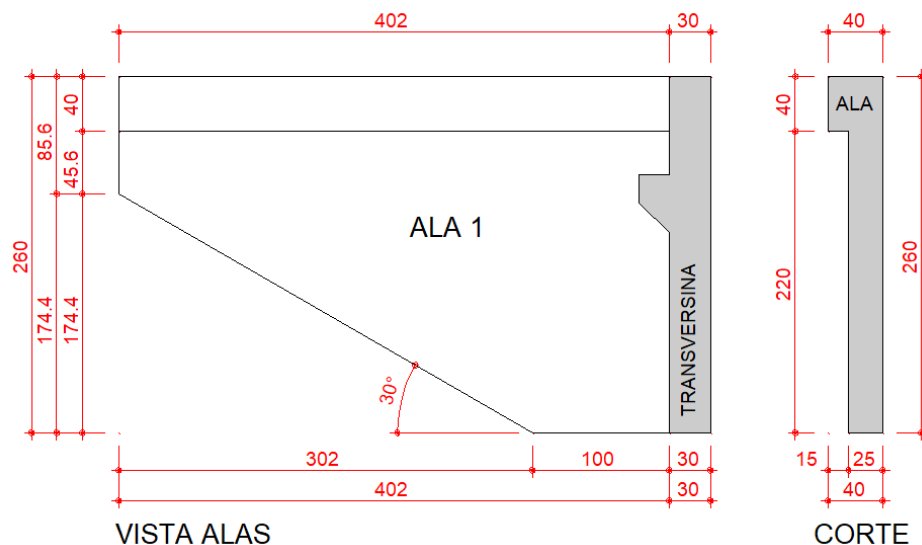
Detalhe das transversinas de apoio – Proposta 2
